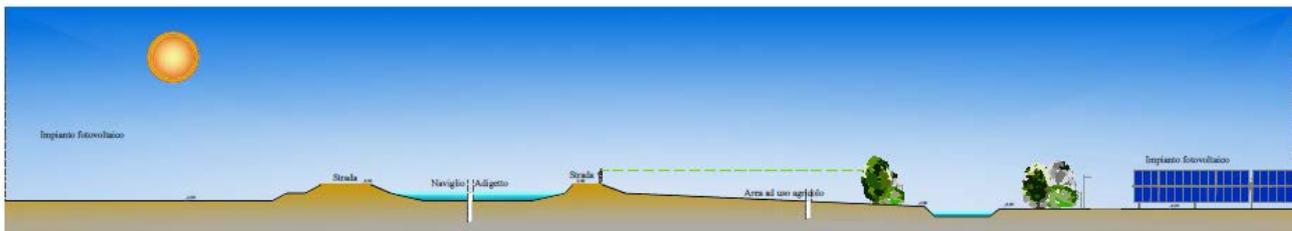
/92 – Sezione di intervisibilità dal punto di vista chiave n. 6 dal lato nord, dall'argine dx del ramo morto del Canalbianco (località Retinella)
